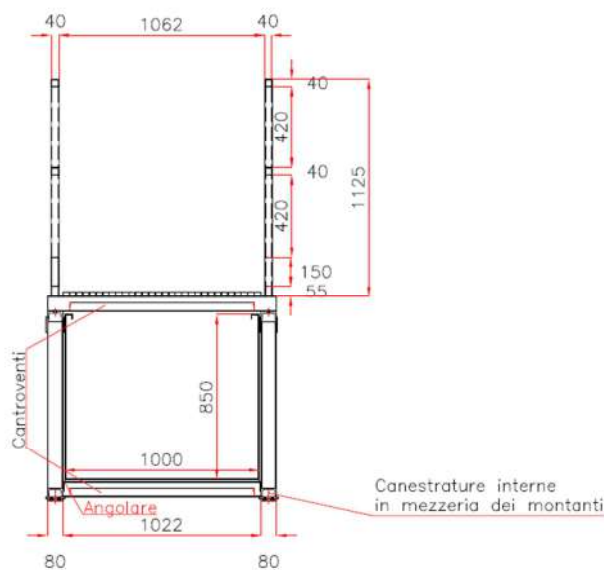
Sezione trasversale tipo dei tre attraversamenti
